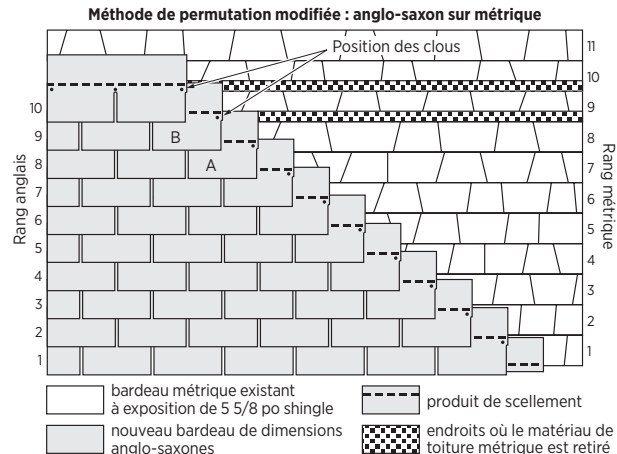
Réfection d'un toit au moyen de bardeaux standard de 12 po x 36 po sur des bardeaux métriques.
